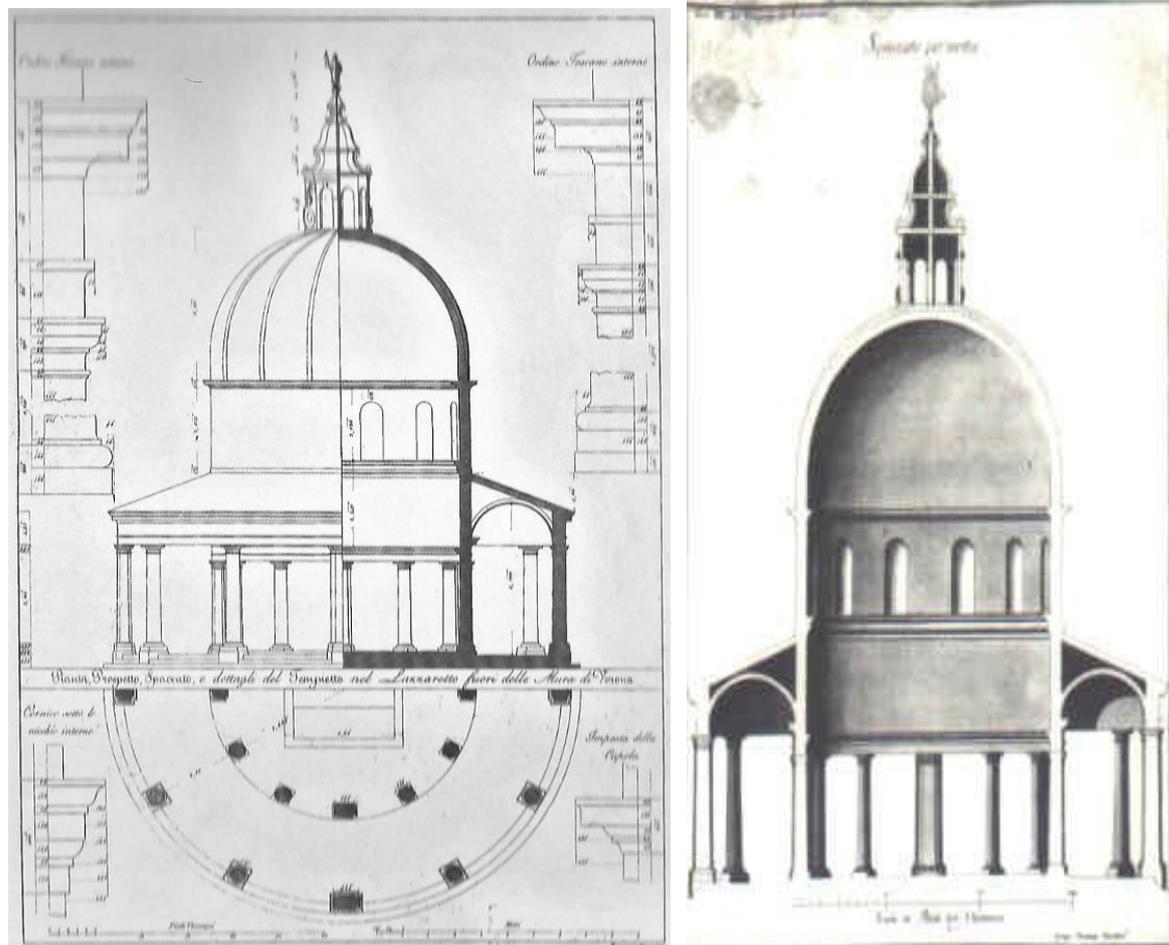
Il tempietto del Lazaretto. Da trattati di architettura (XVIII secolo)
